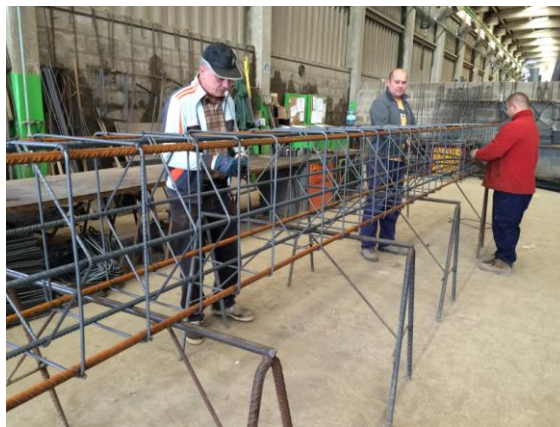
Construção da armadura para posteriormente se inserir na cofragem
